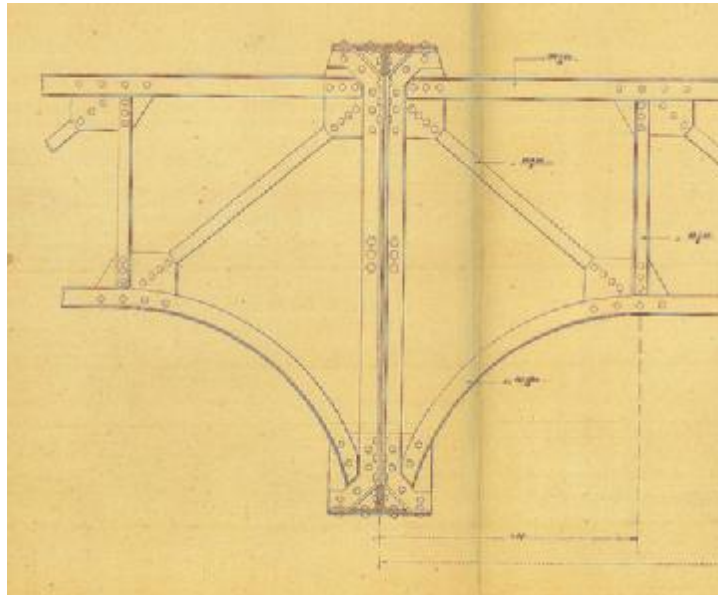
Detalle de correa de cubierta con placas de cubierta.
